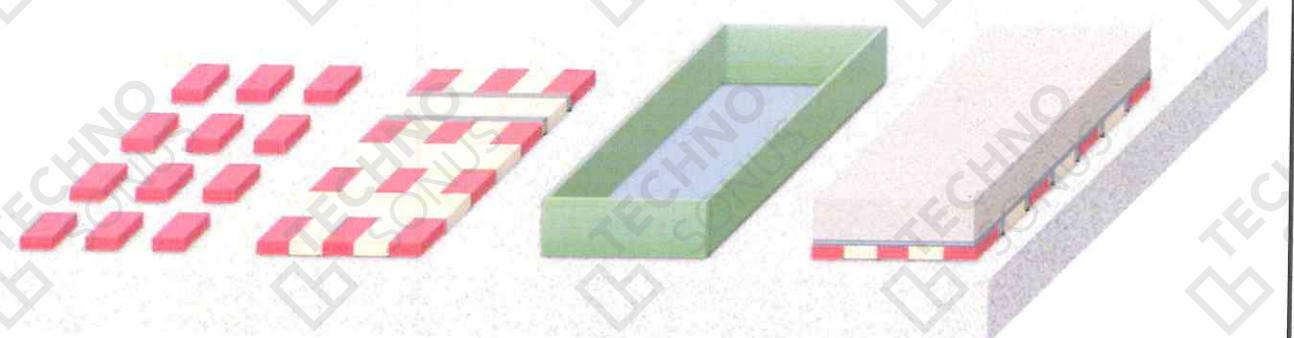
Схема монтажа точечной раскладки (тип С) виброизоляционного материала под индивидуальный фундамент.
